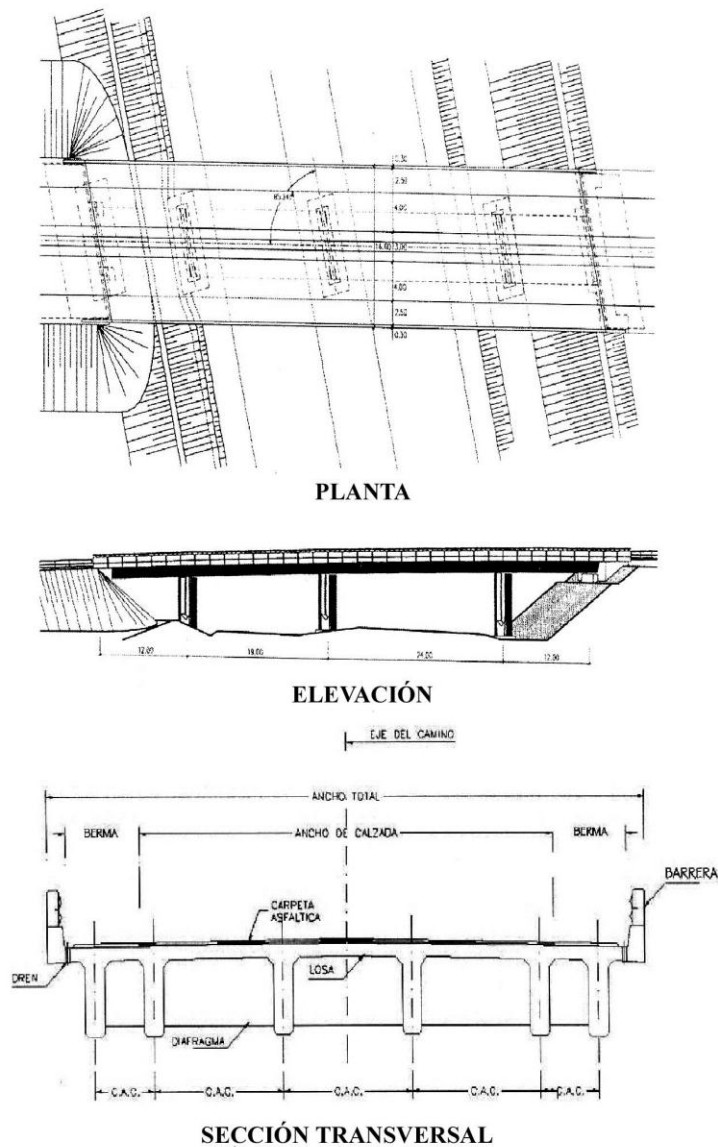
Vista en planta, elevación y sección transversal de un puente típico de concreto
